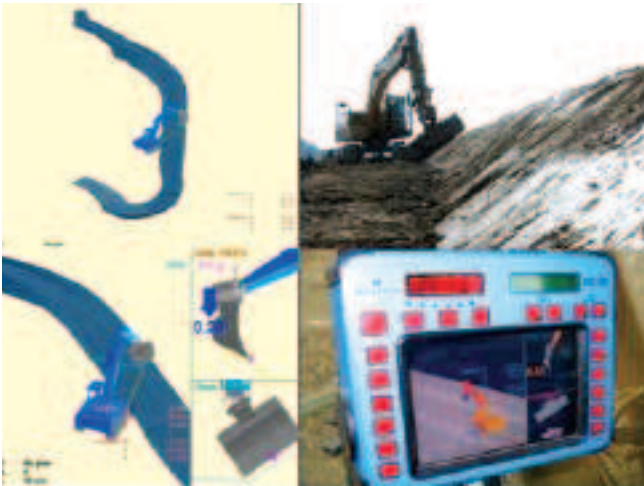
Fase di rimodellazione dell'appezzamento con particolare del software montato a bordo dell'escavatore.
